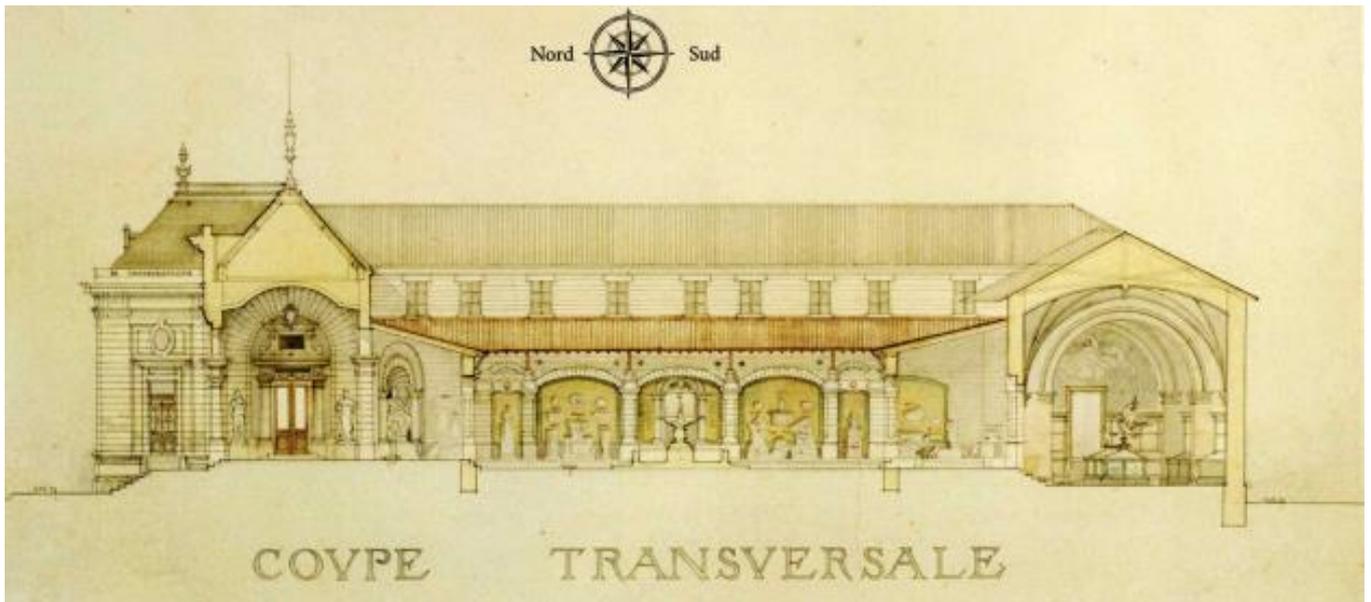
Avant -projet du musée en coupe transversale par Charles Planckaert
